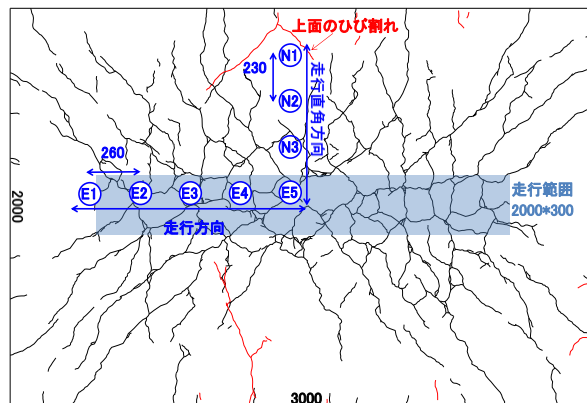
輪荷重走行試験終了時のひび割れ状況
